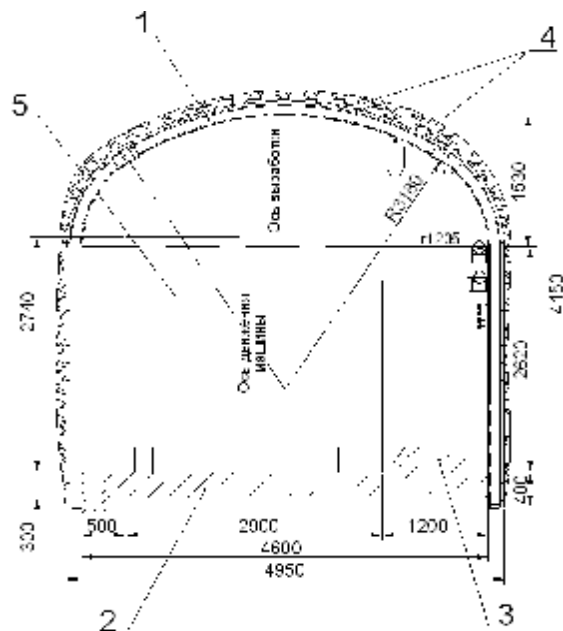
Поперечное сечение наклонного ствола №5-Г на участках неустойчивых пород: 1 – арочная рамная крепь (СВП-27); 2 – дорожное покрытие (бетон); 3 – пешеходная дорожка (бетон); 4 – забутовка с цементным раствором; 5 – автосамосвал для подземных работ EJC-530 (SANDVIK)
